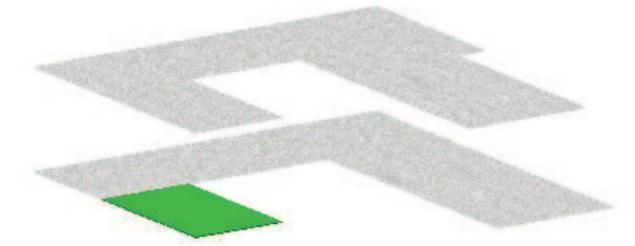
Grundriss Krippe\_Erdgeschoss
